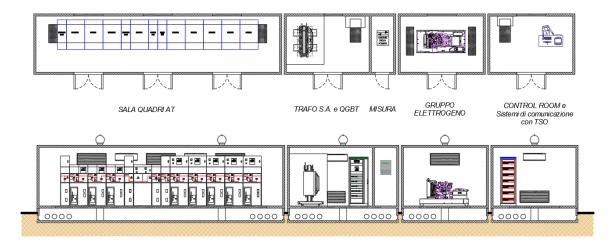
Particolare pianta e sezione cabina di raccolta e smistamento (Rif. FV.ALCO1.PD.H.02)
